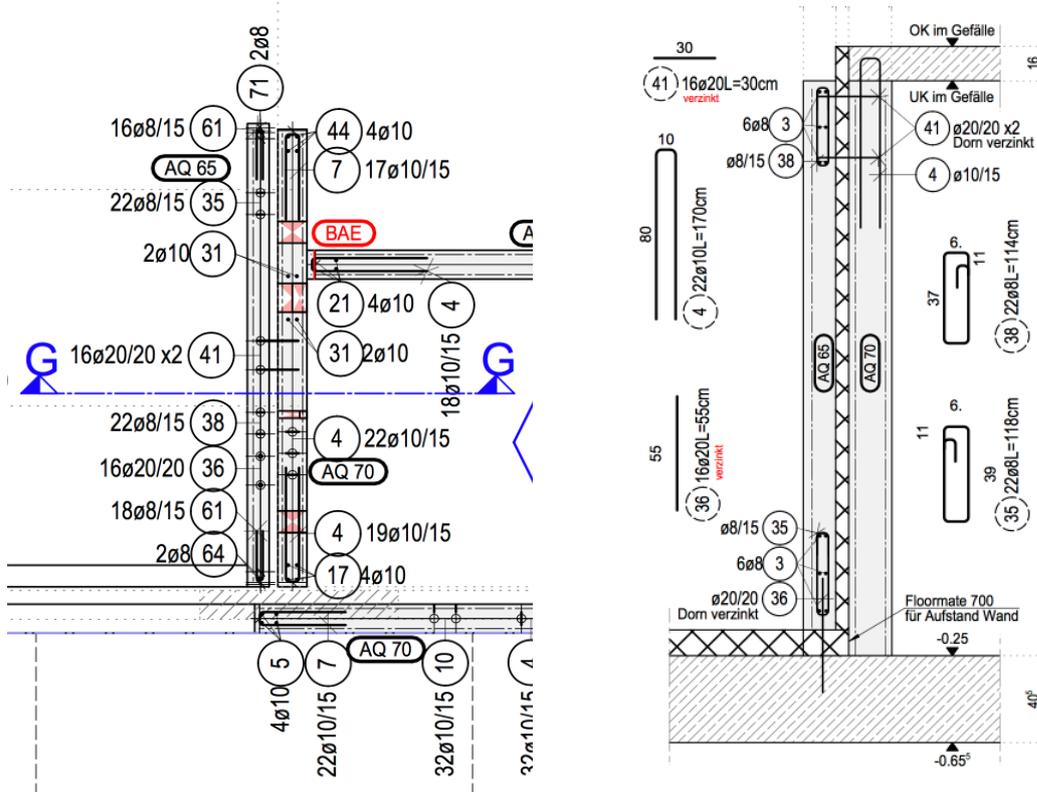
Bewehrungsplan im Grundriss und Schnitt G-G
